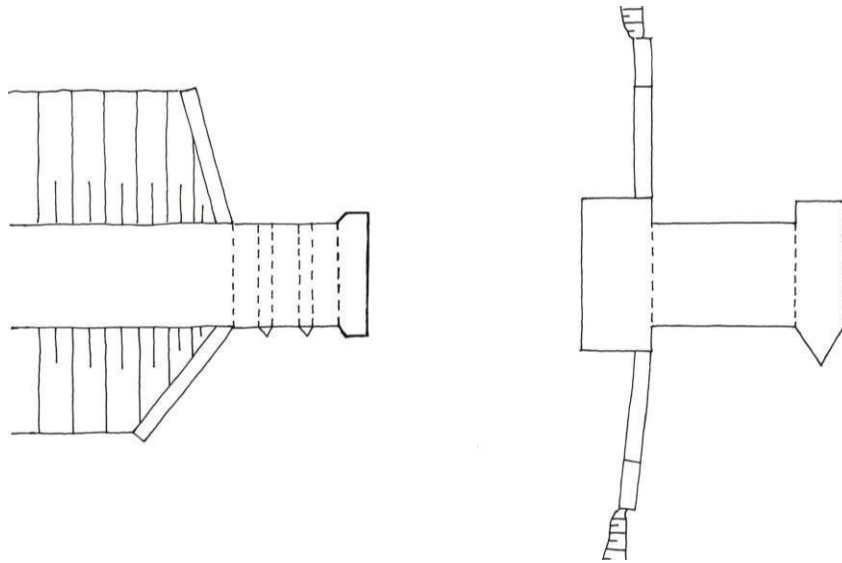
Planta de la margen izquierda con el vano abierto entre el puente y la alcantarilla de desagüe
